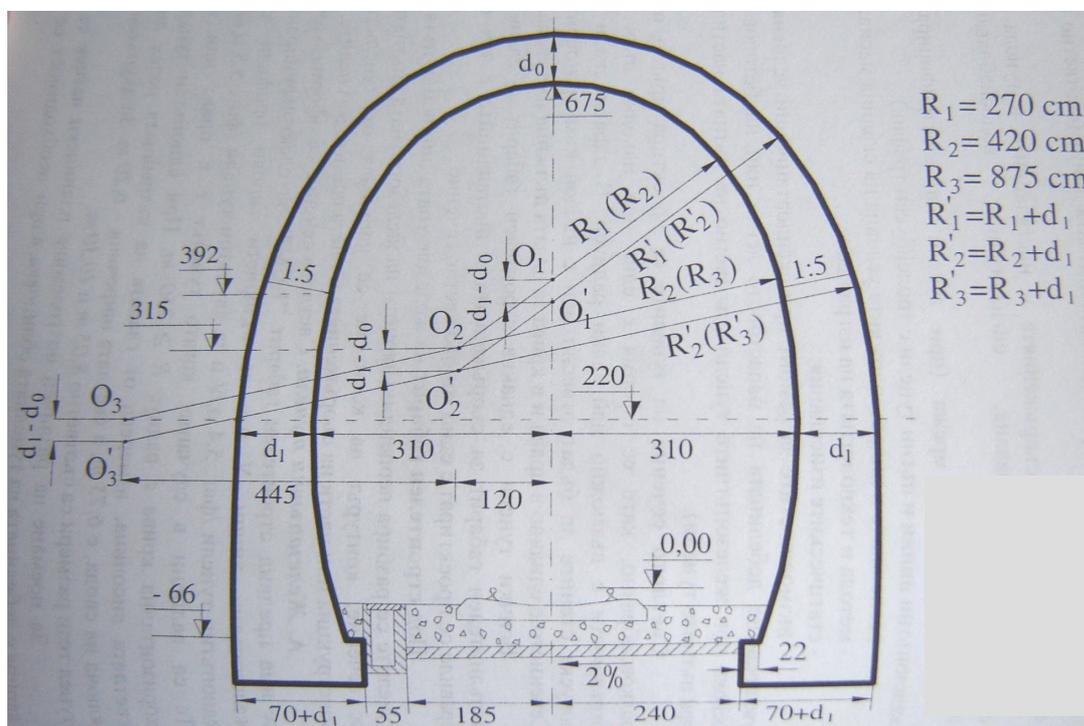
Typenprofil für einspurigen Eisenbahntunnel
